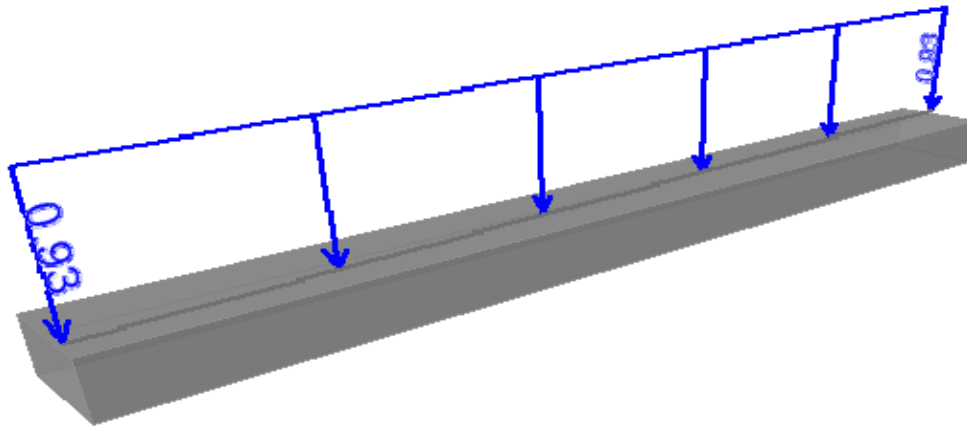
Cargas muertas en viga chata ( Ton x m )
